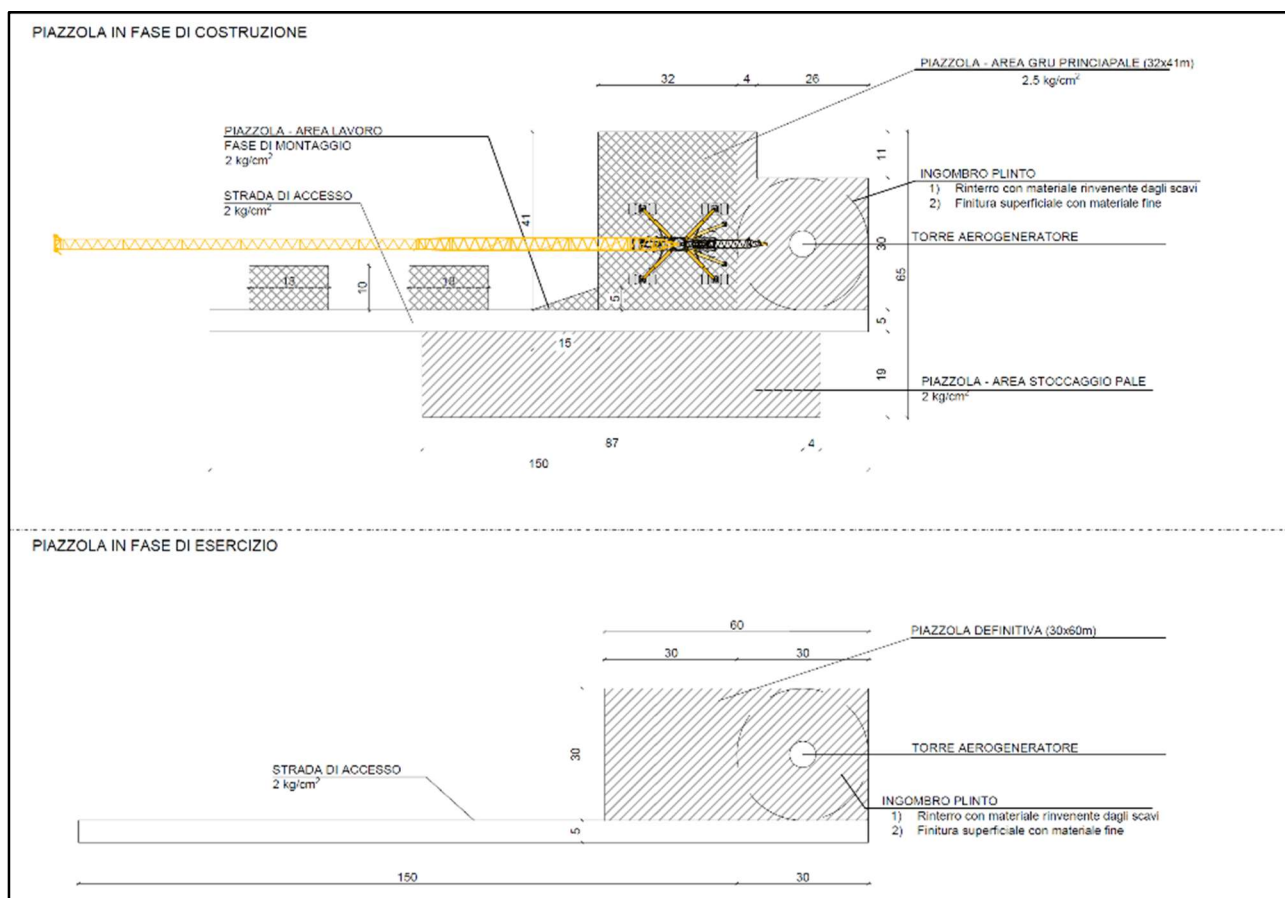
Planimetria piazzola tipo per la fase di costruzione e la fase di esercizio e manutenzione
